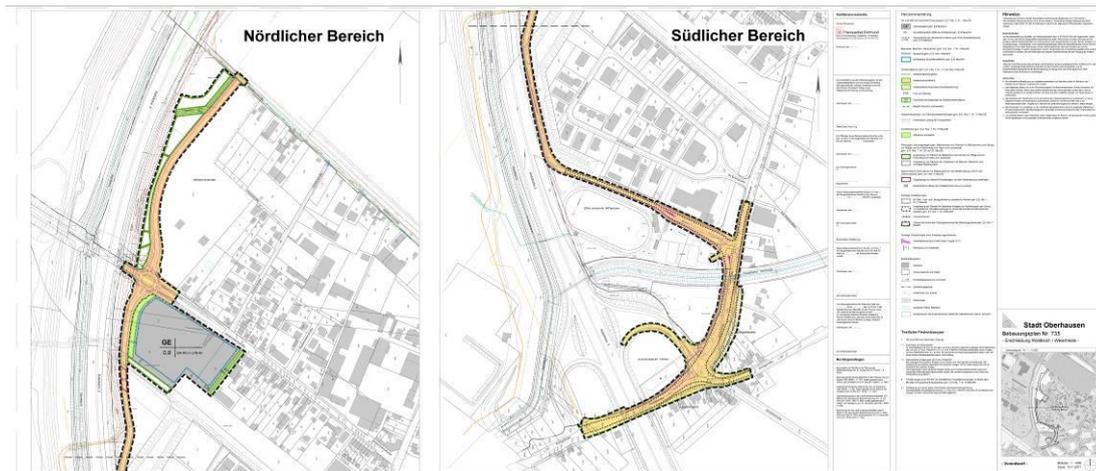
Bebauungsplan 735 „Erschließung Waldteich / Weierheide“ (STADT OBERHAUSEN 2017)
